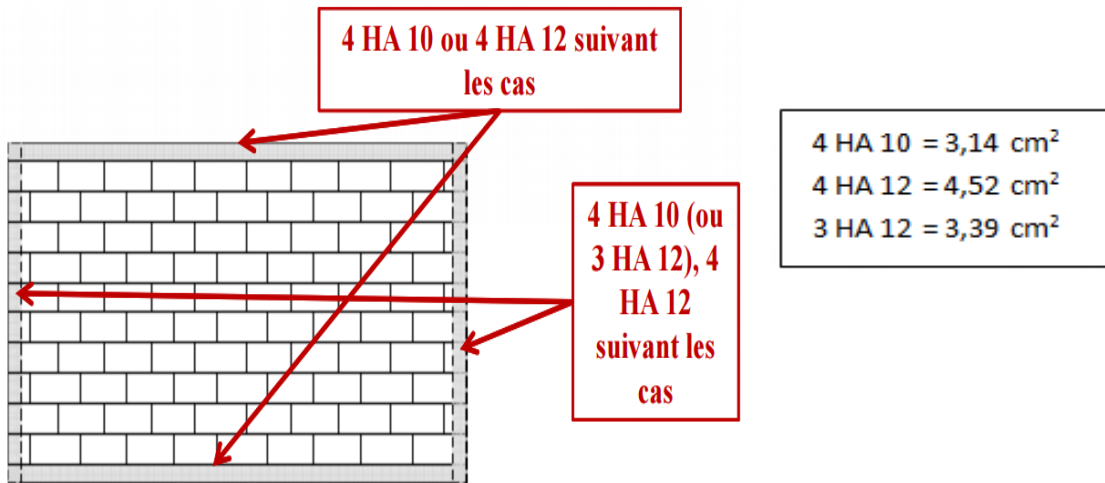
Dispositions constructives de renforcement parasismique dans les maçonneries chaînées
